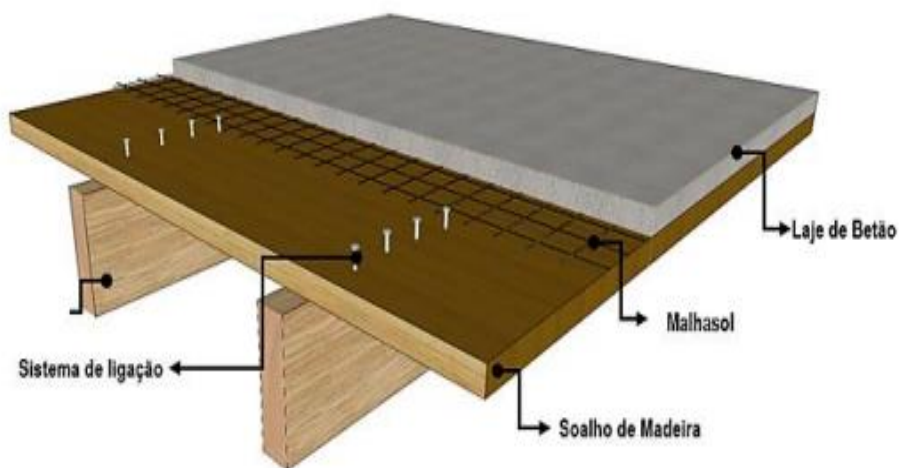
Representação de uma Laje Mista Madeira-Concreto (Betão)
